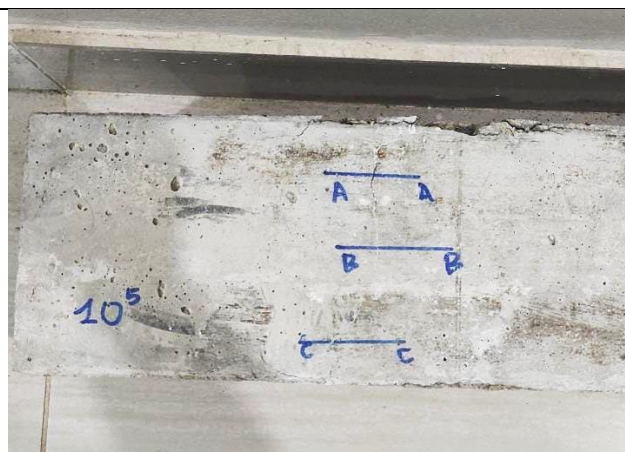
Viga de bioconcreto 1×10^5 cel/ml fisurada, después.
